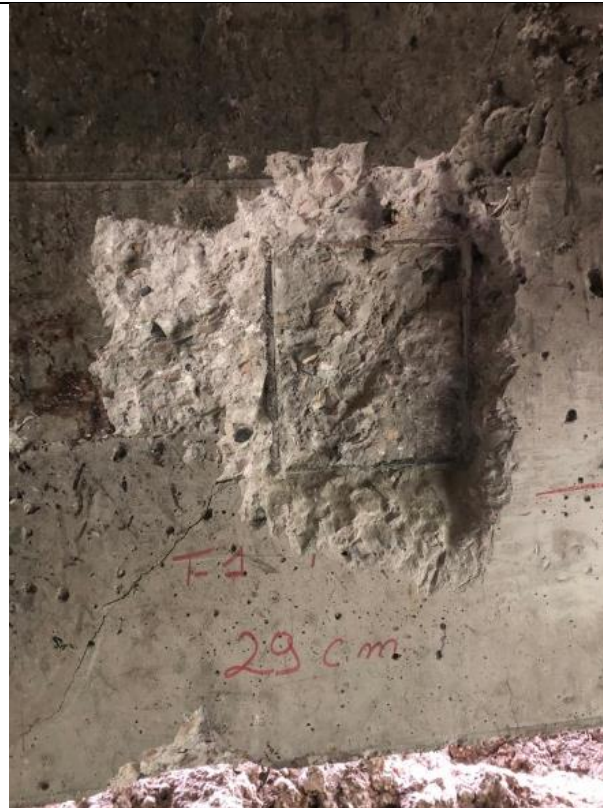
Acero de refuerzo transversal existente en la viga del puente .
